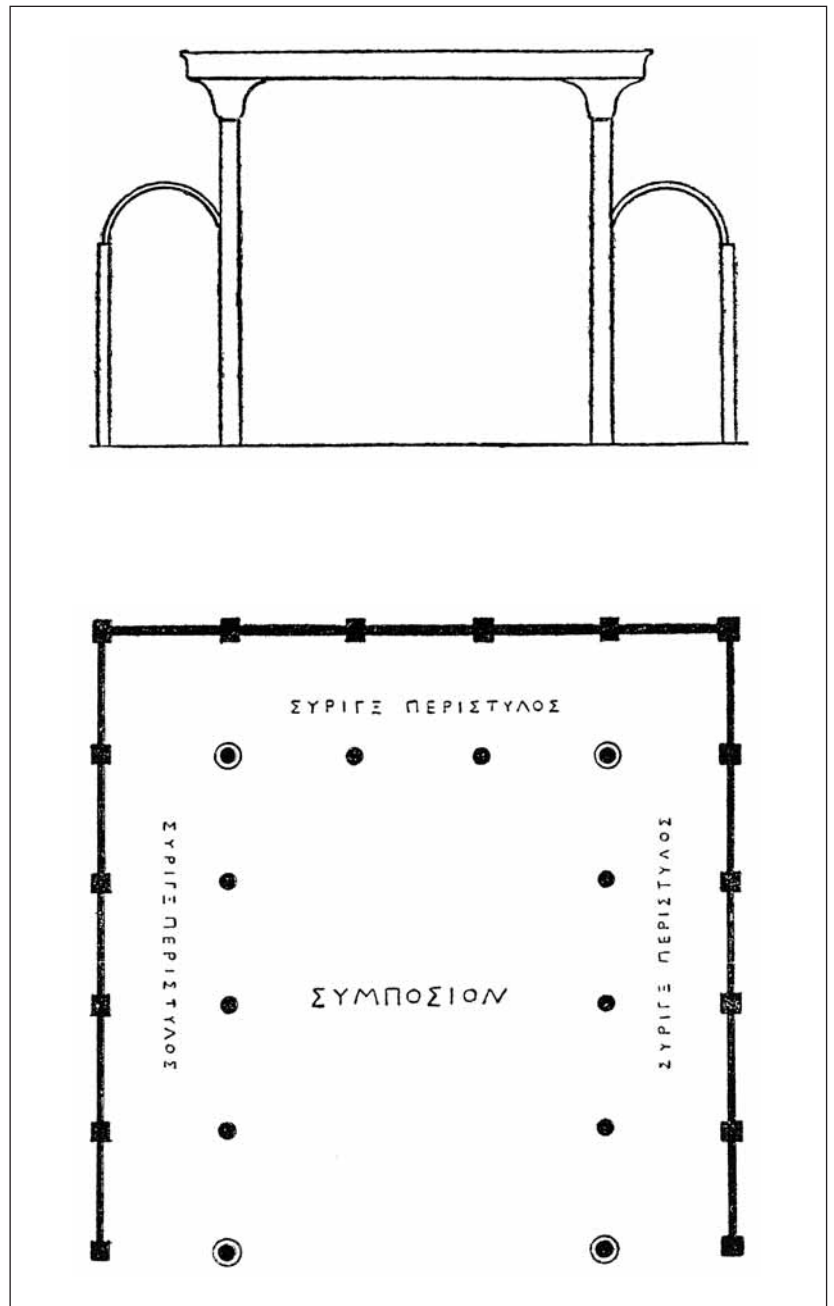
Alexandria, Bankettbau. Schematische Rekonstruktion in Grund- und Aufriss nach Leroux 1913
